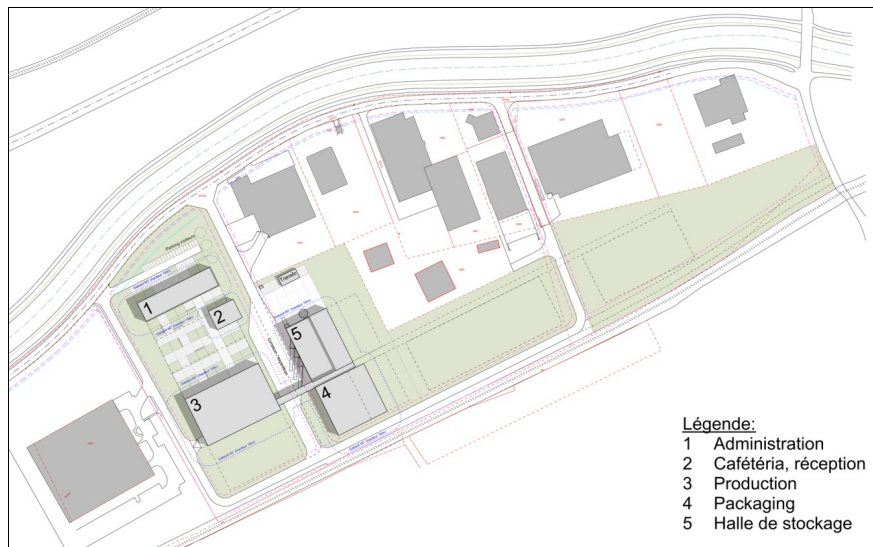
Plan d'alignement sanctionné en 2012 (source : urbaplan)
